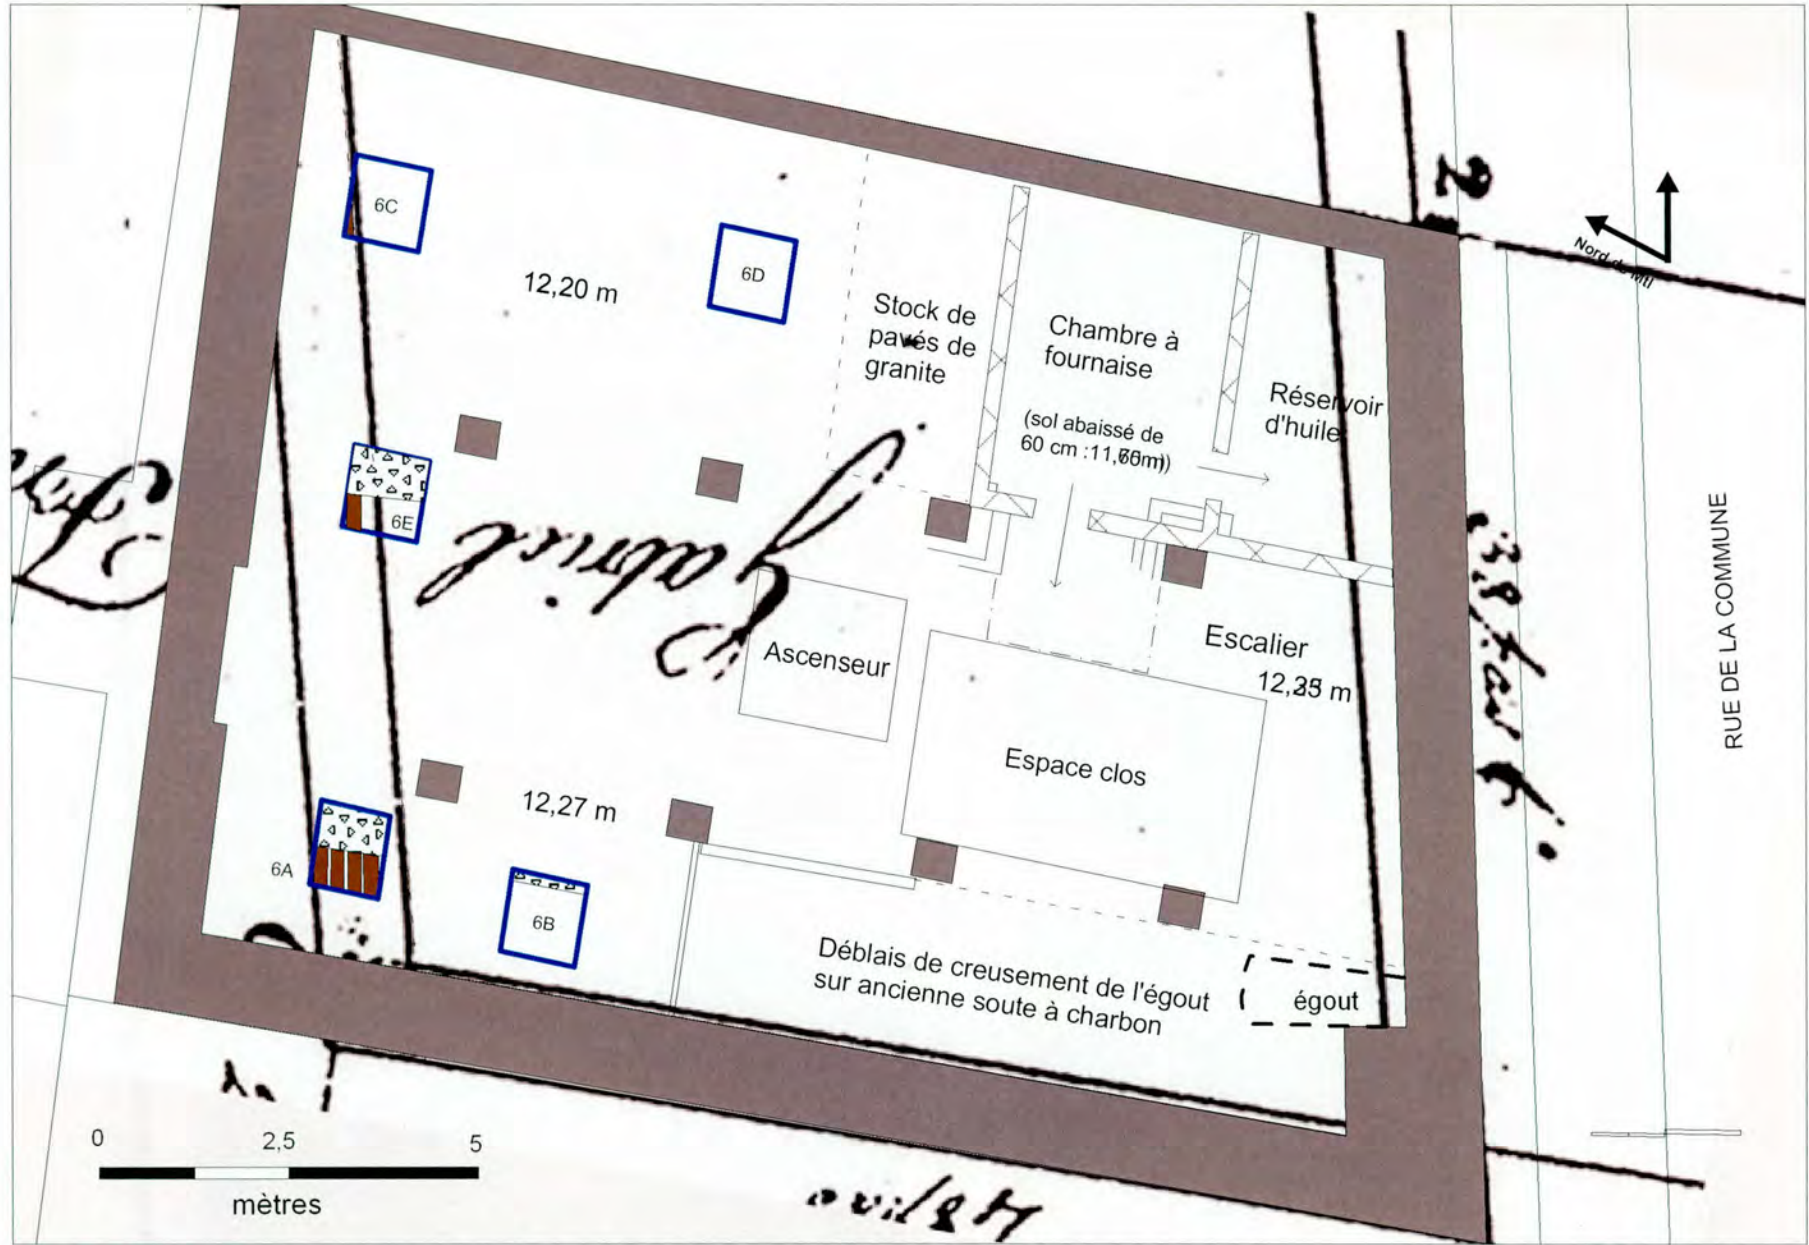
Bâtiment Robert-Gillespie (1) (211, rue de la Commune ouest) - Localisation sur le plan de Louis Guy (1800)
